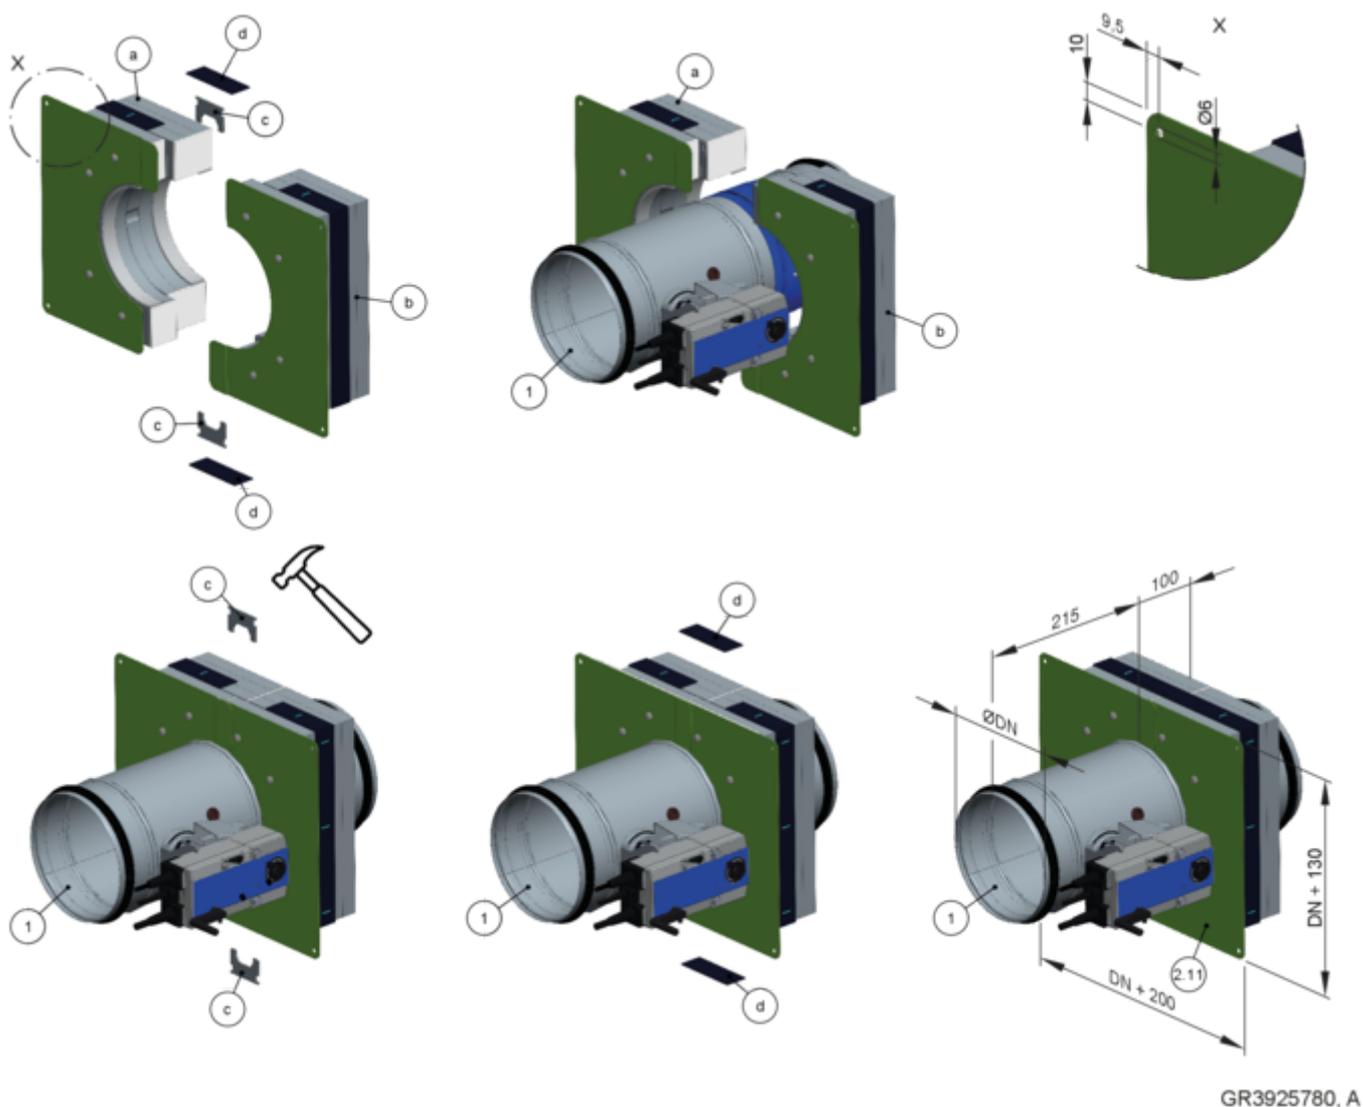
Lieferumfang und Montage Einbausatz TQ2 für Trockeneinbau
